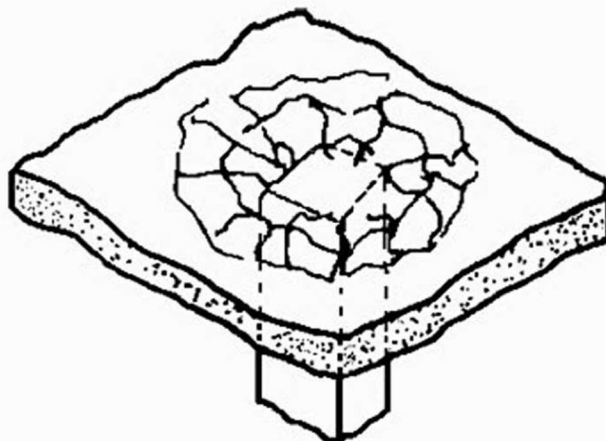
Configurações de fissuras em função do tipo de sollicitação.
